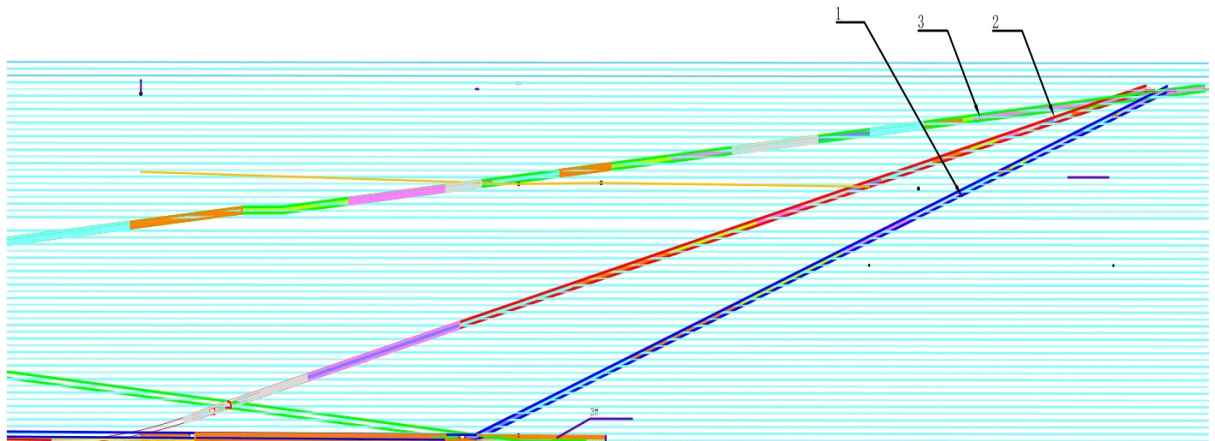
Вертикальная схема вскрытия: 1 – вентиляционный ствол, 2 – главный ствол, 3 – вспомогательный ствол
